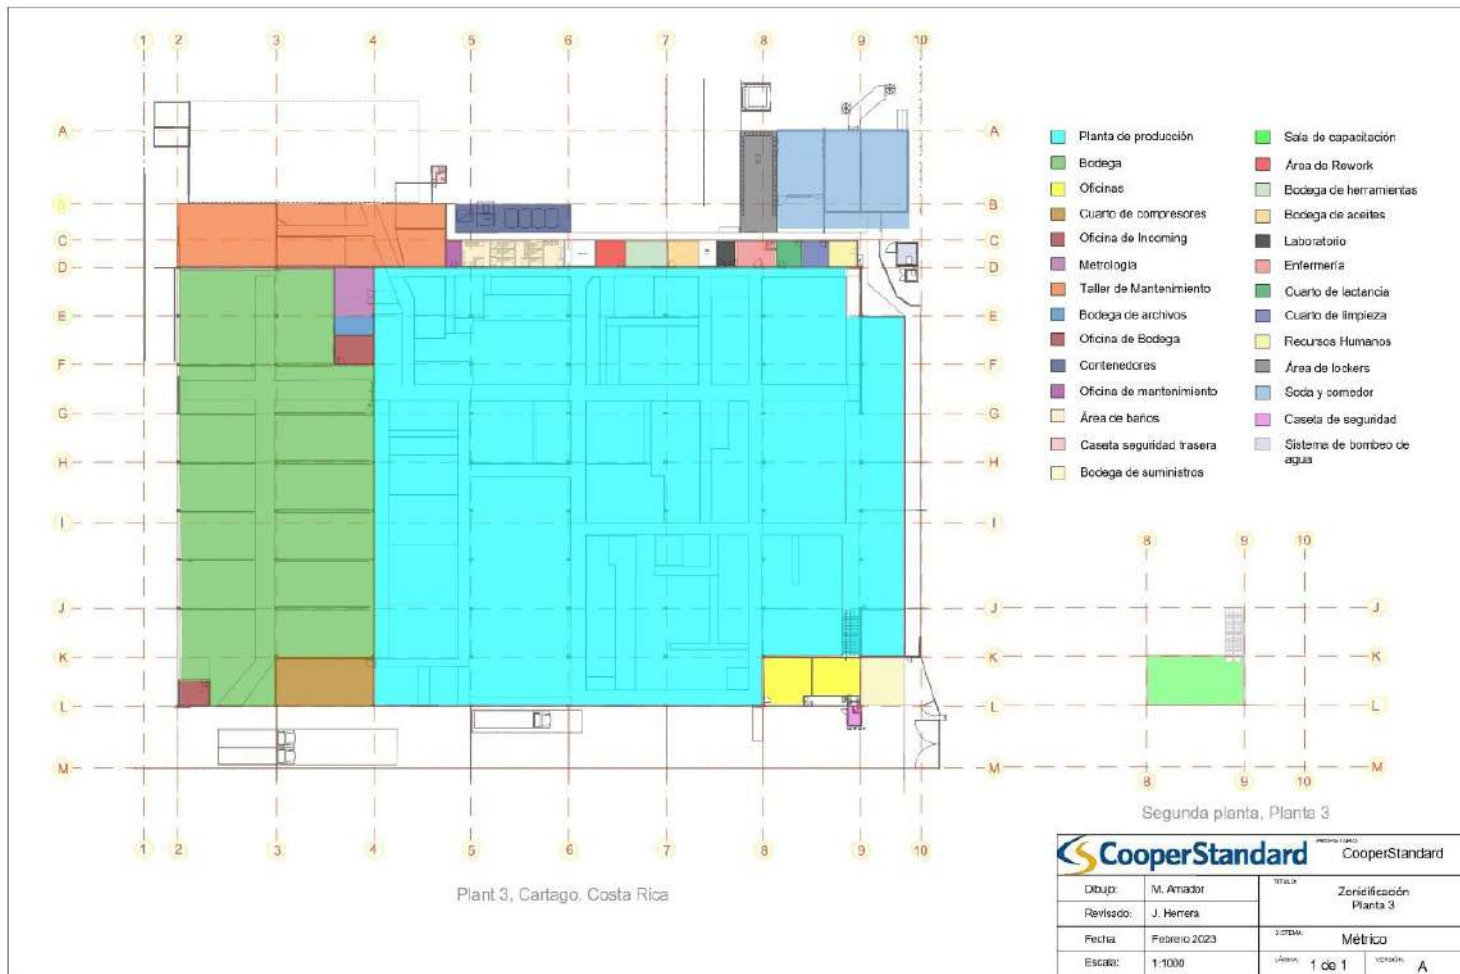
Plano de Zonificación de Planta 3 Fuente: Elaboración propia, realizado en AutoCAD (2023).
